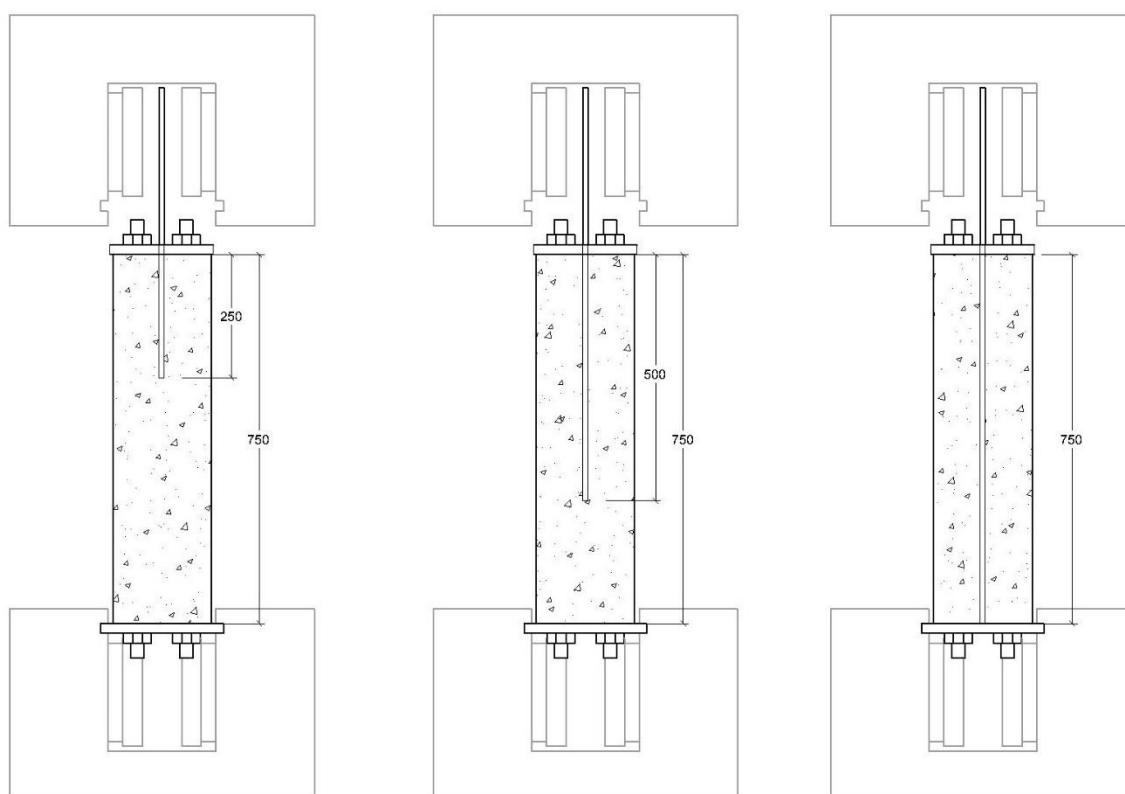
Esquema simplificado do ensaio de arrancamento com longo comprimento de ancoragem
